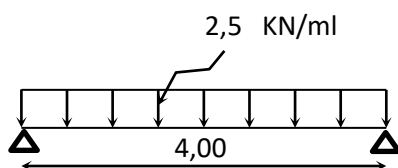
Schéma statique de la poutrelle et son chargement avant coulage de la dalle de compression.
